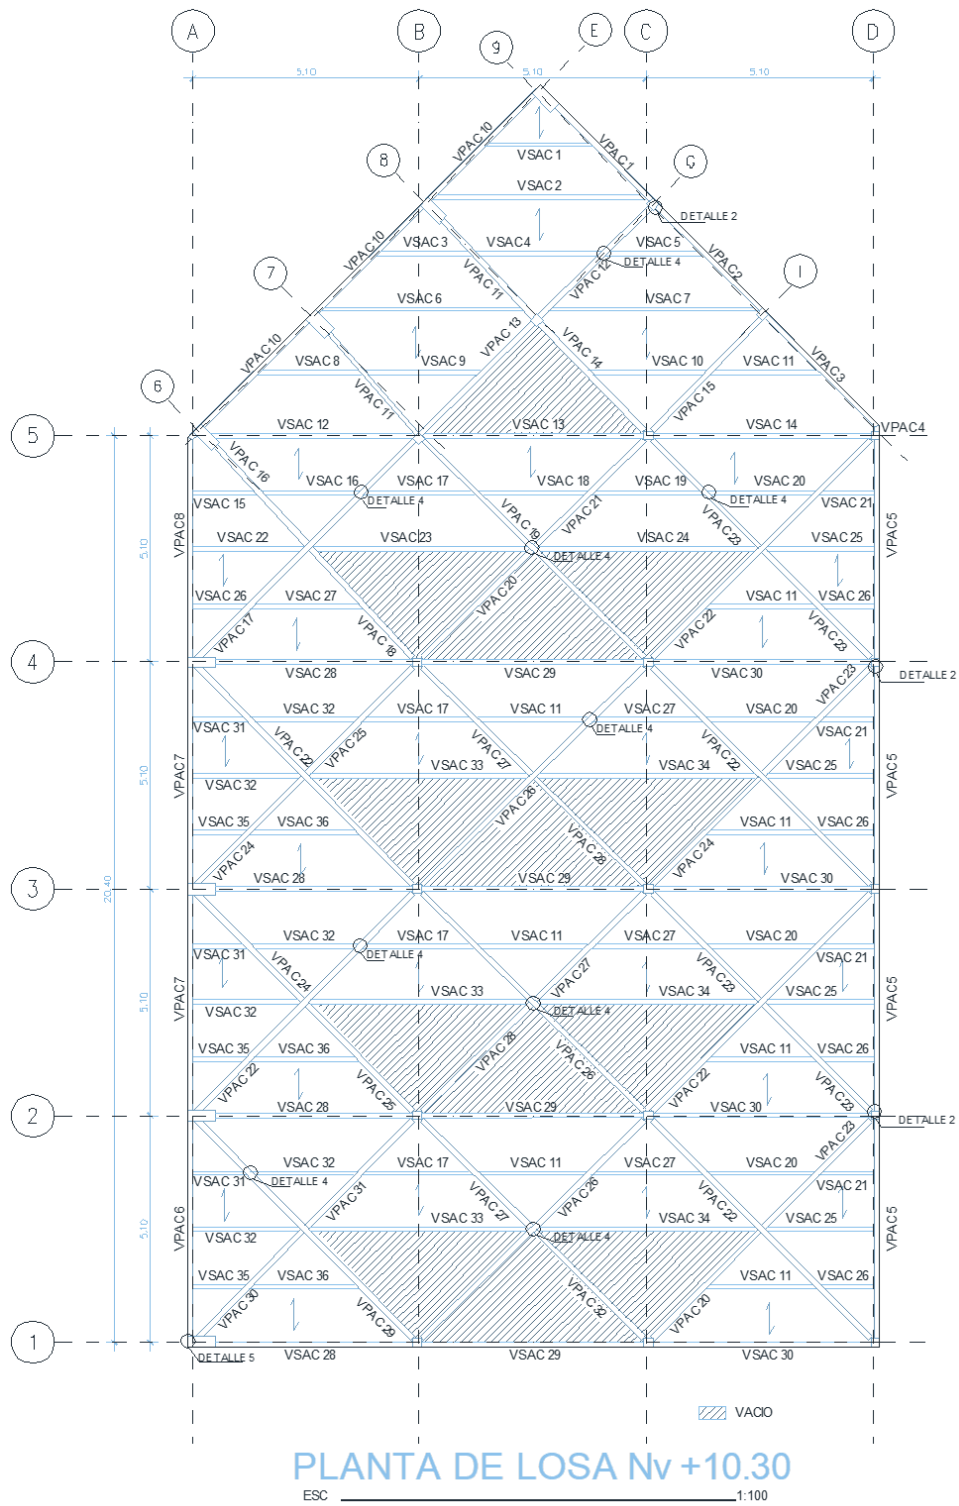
Plano Estructural Planta de Losa Nv +10.30 [25]
